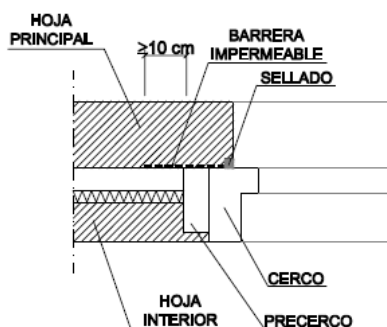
Detalle encuentro carpintería y cerramiento
